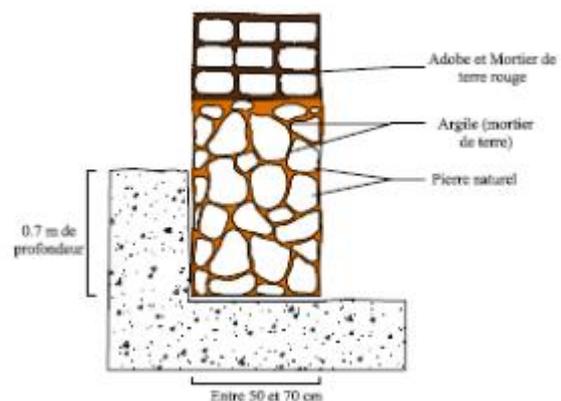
Détail de fondation Echelle 1/40 (Auteur, 2014).
